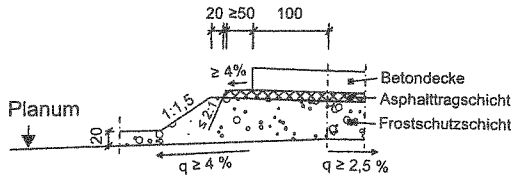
Randausbildung einer Betondecke auf einer Asphalttragschicht
